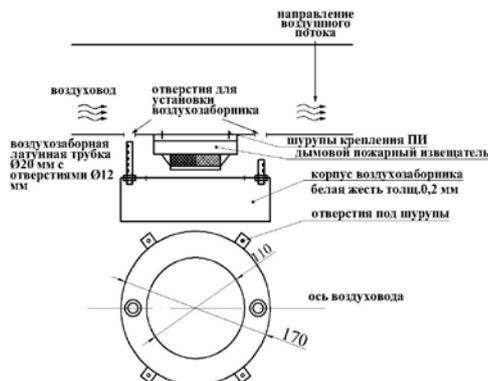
Устройство воздухозаборника для обнаружения дыма в воздуховоде
